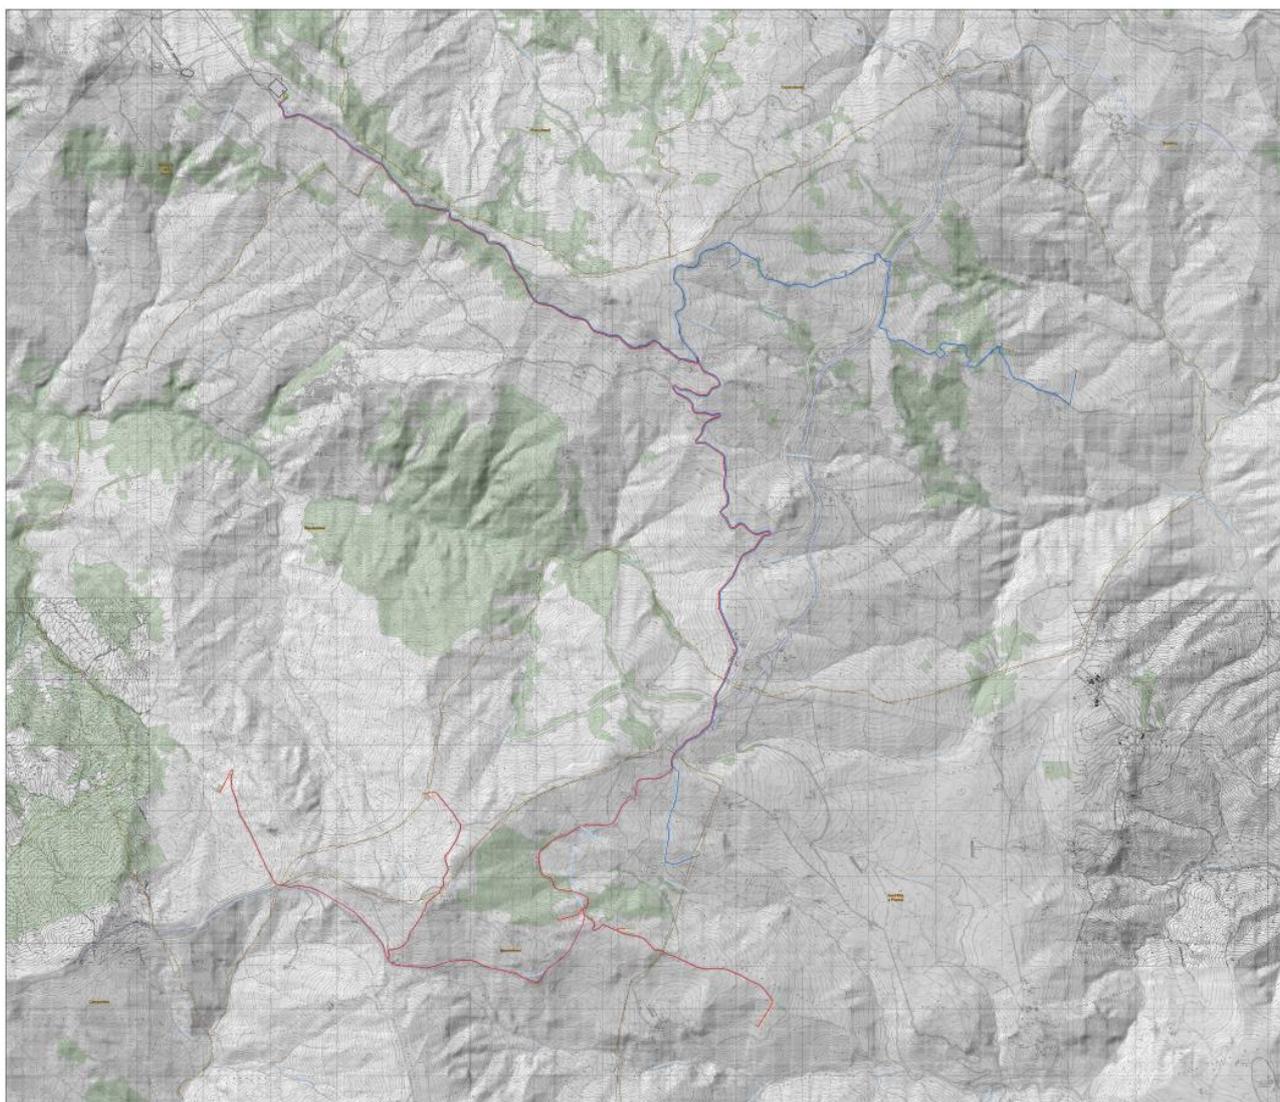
Localizzazione delle strade di progetto e di accesso alle WTG (Stralcio dell’elaborato 9.1_PlanimetriaGenerale)
